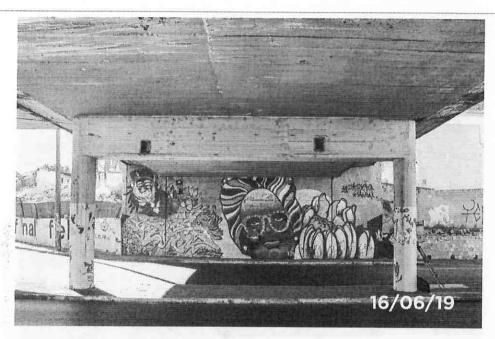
Vista dos pilares com a viga travessa apresentando bolor e caixa de passagem de elétrica sem tampa.
